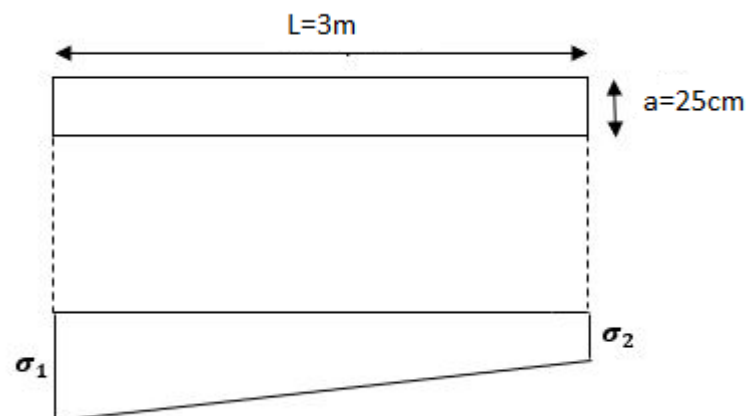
Schéma d'un voile plan et disposition du ferrailage
